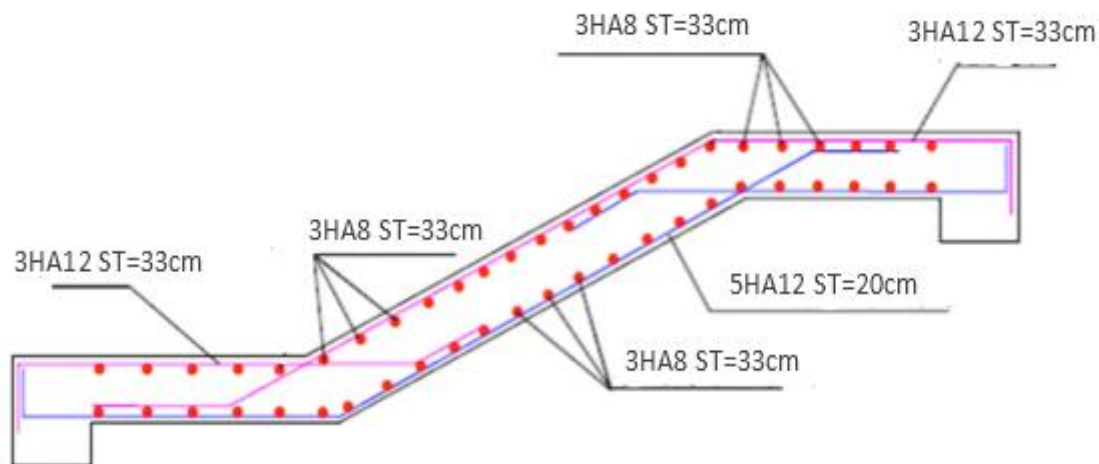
Schéma de ferrailage de l'escalier étage courant
